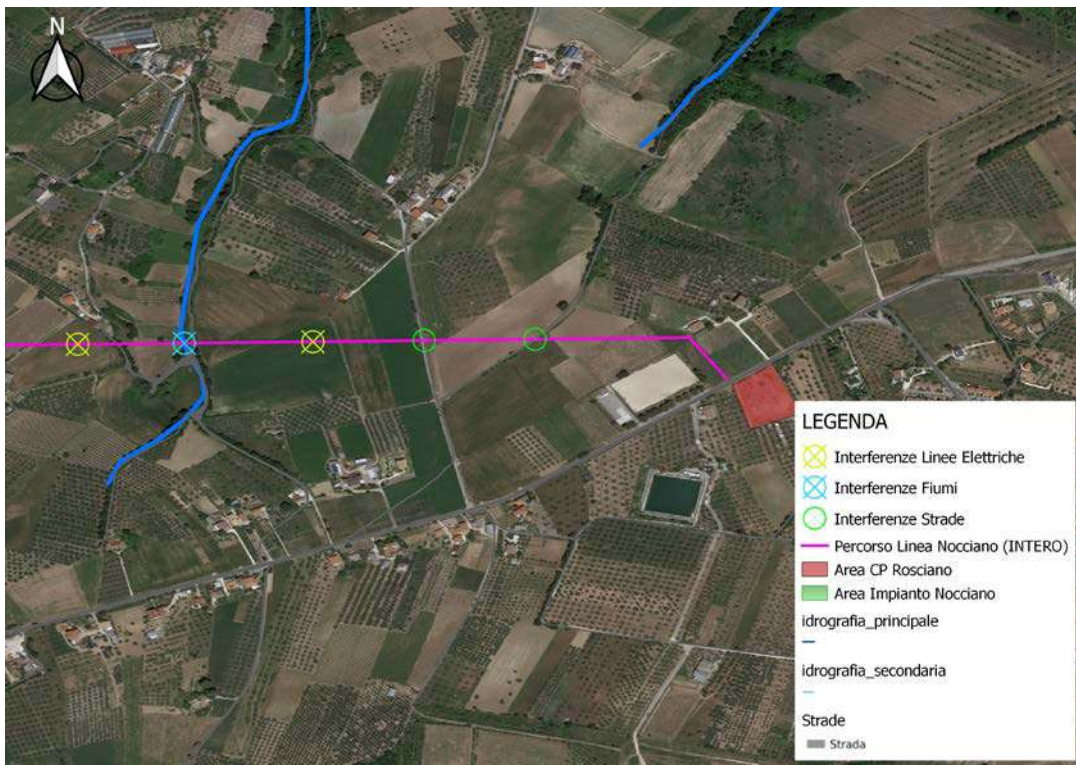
PLANIMETRIA DELLE INTERFERENZE N. 4 DI 4
